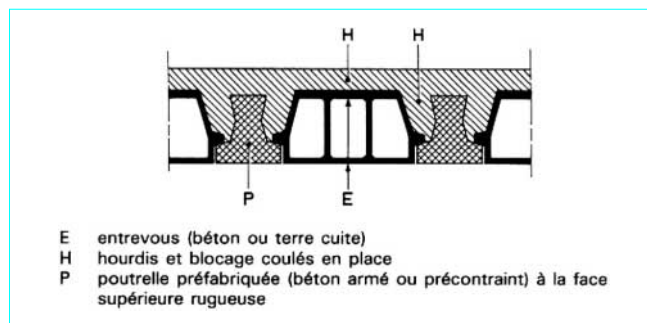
Plancher à poutrelles préfabriquées et entrevous
